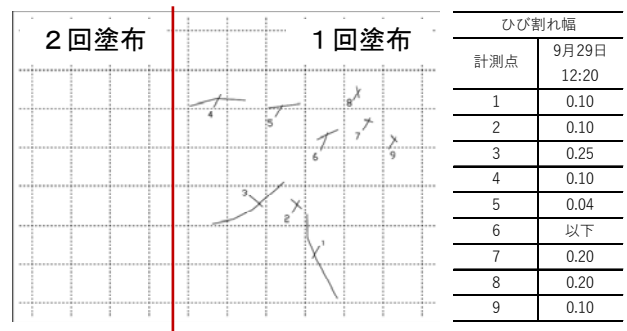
ひび割れ発生状況 (散水有り24時間)
